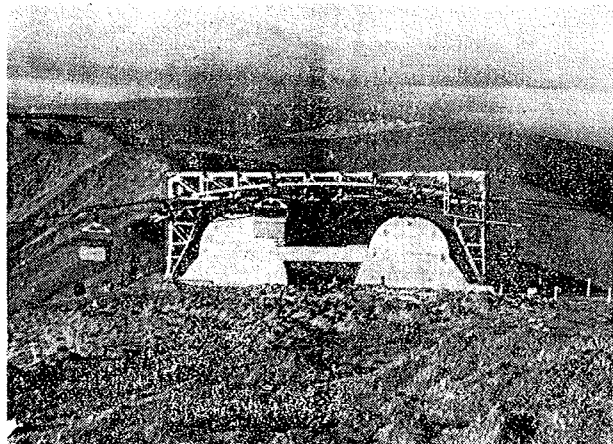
DISPOSITIVO II°: Protezioni costituite da elementi ad U di diaframma collegati da travature di sommità.
